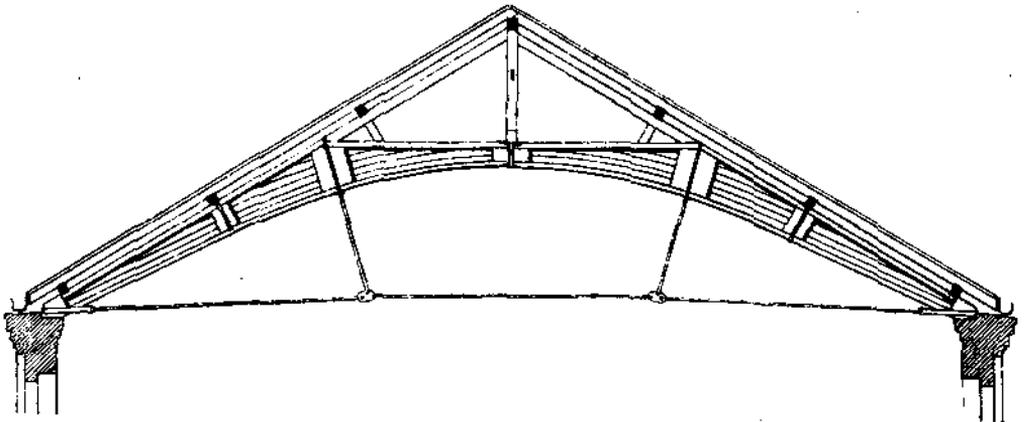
интересное арочное, шарнирное перекрытие с прямолинейными верхними поясами, которые весьма удобны для устройства прямой двухскатной крыши. Распор уничтожен затяжкой из железных стержней, укрепленных к чугунным башмакам, служащим опорами для нижних частей фермы.
